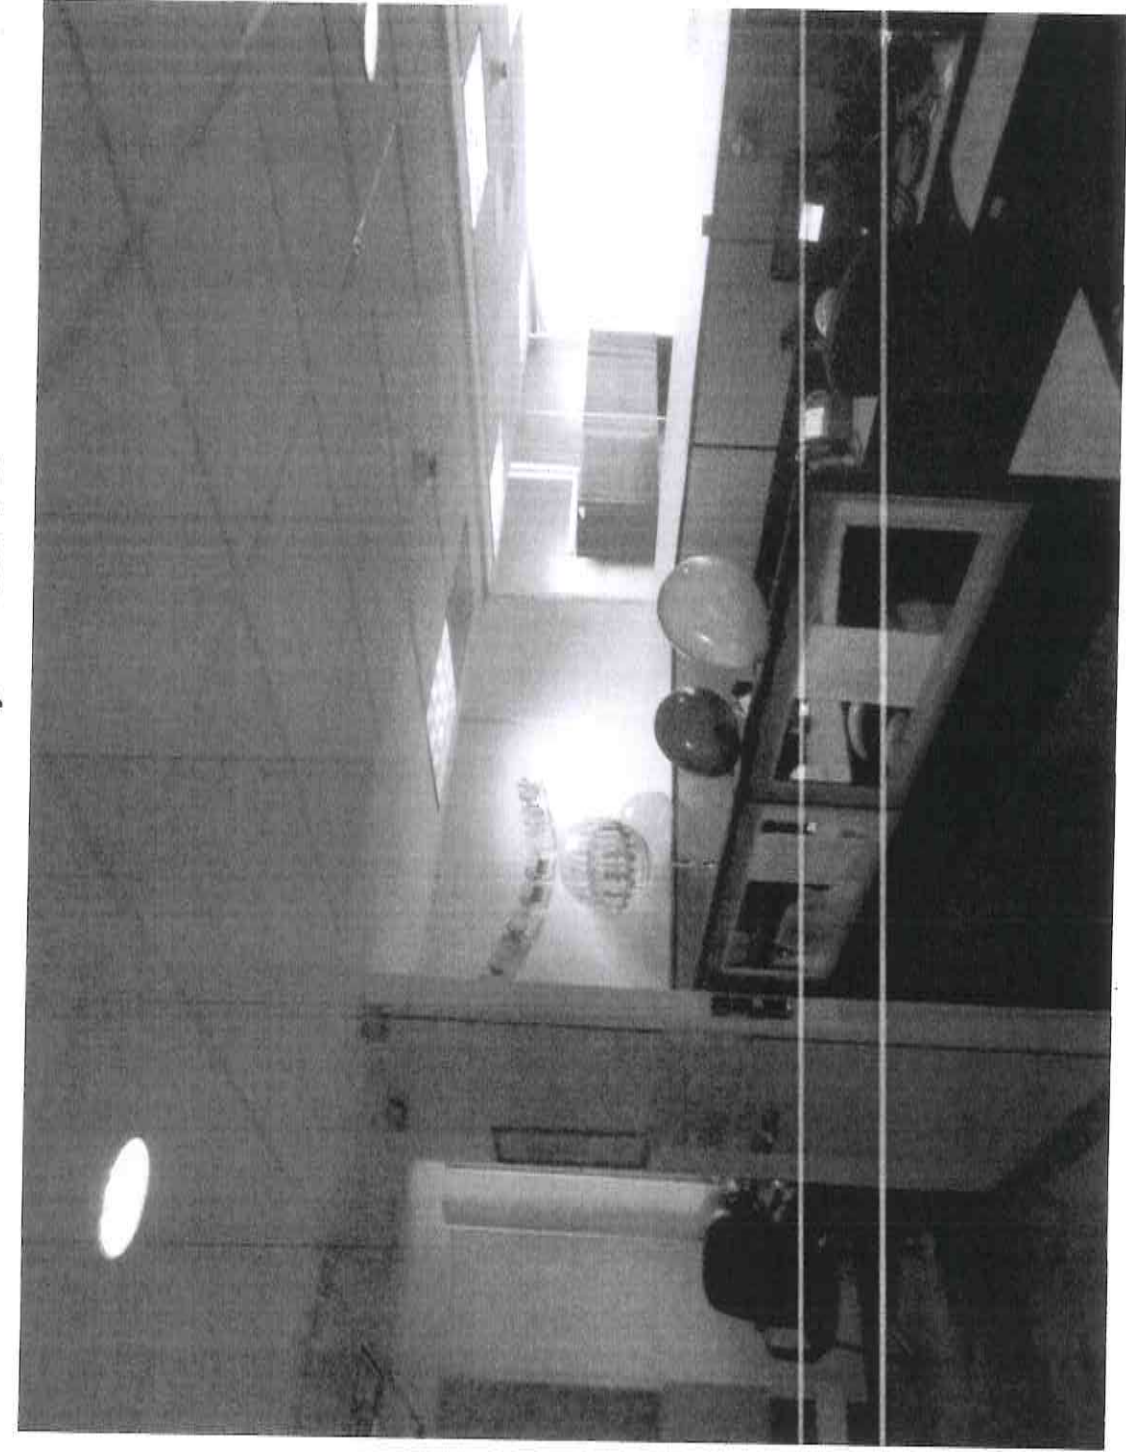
Vista exterior de cubo de elevador sin daño estético ni estructural
